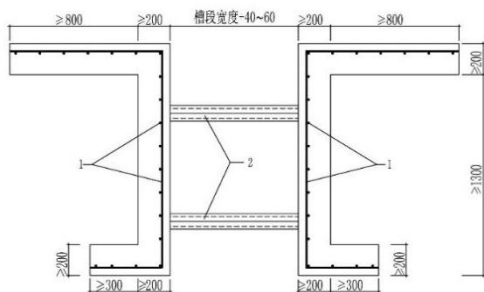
倒“[”型导墙示意图（单位：mm）
